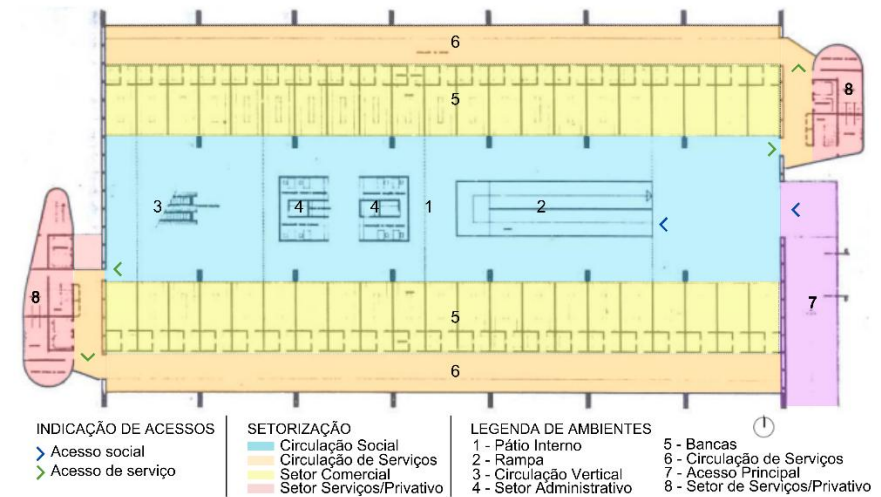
Planta do pavimento térreo setorizada. Fonte: Adaptado de Revista Acrópole (1967, p. 36).
